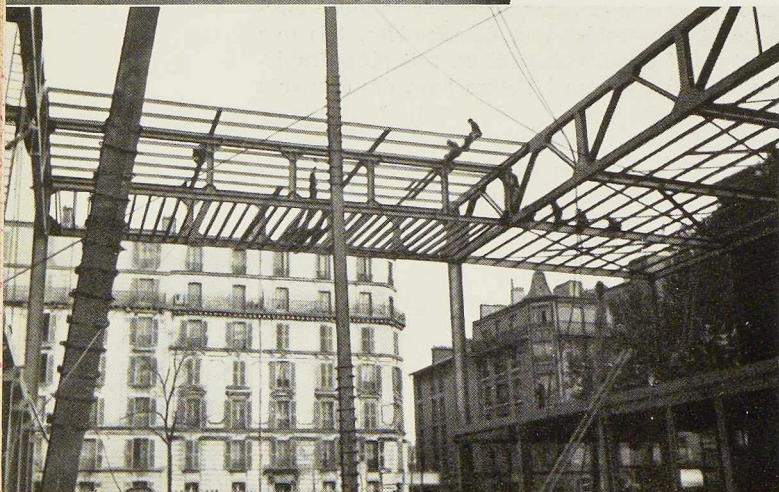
La poutre en treillis, de 27^m00 de portée et 2^m75 de hauteur, reçoit le rail de roulement du comble mobile, dont on voit le montage d'une des fermes. Cette poutre supporte, d'autre part, les toitures latérales.
